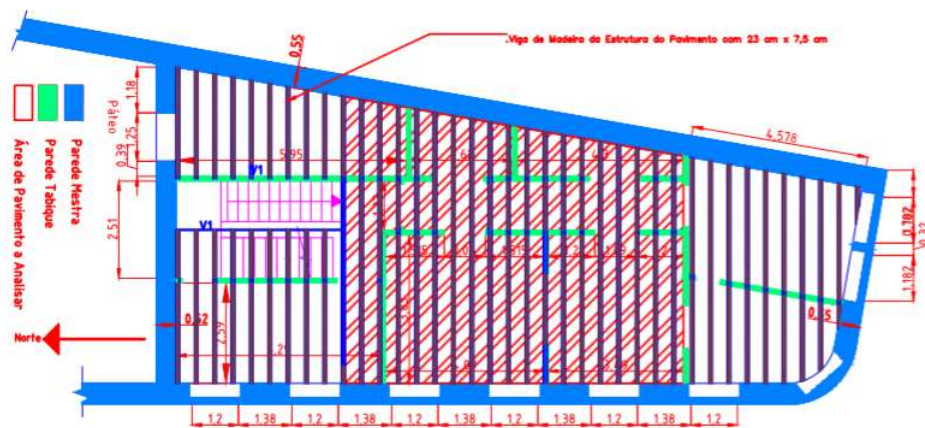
Estrutura deduzida do Primeiro Andar
